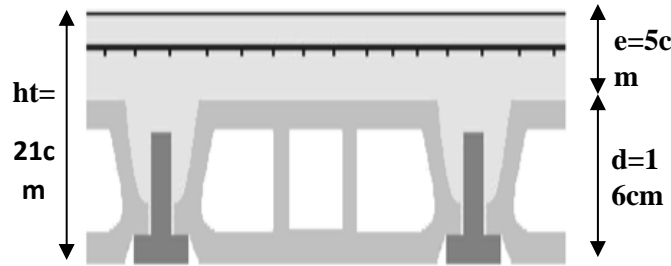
Plancher à corps creux avec une dalle de compression.
